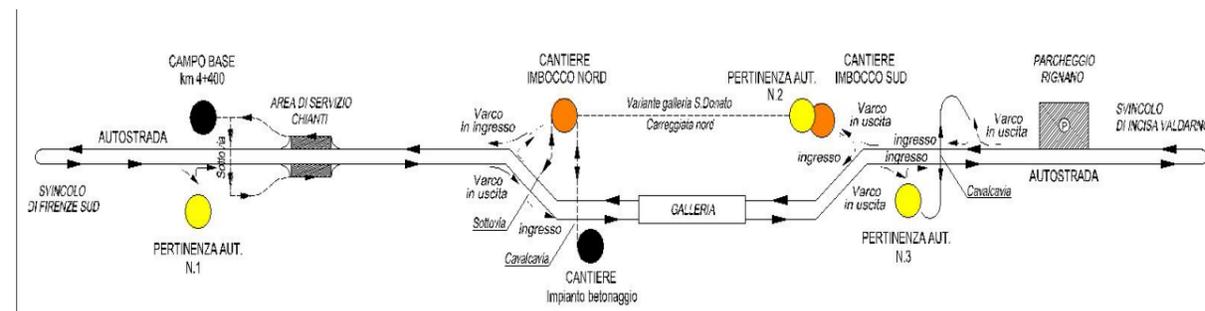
localizzazione cantieri e depositi e loro collegamenti
